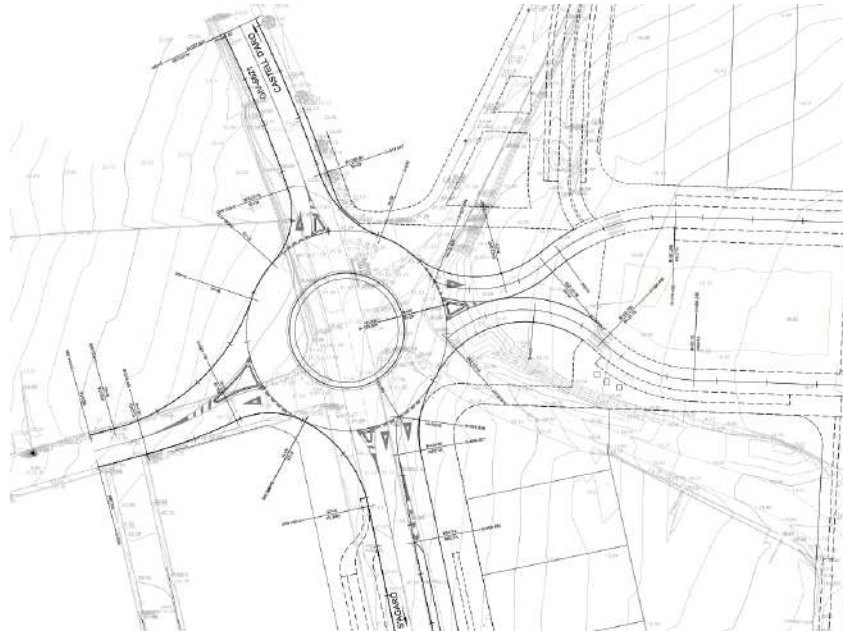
Planta definició geomètrica projecte constructiu de la rotonda.
